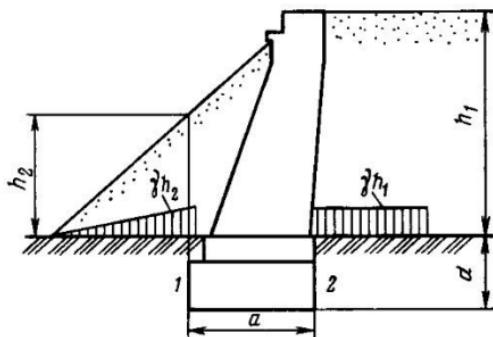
Схема для определения дополнительных напряжений от веса подходной насыпи на грунты основания обсыпного устоя:
